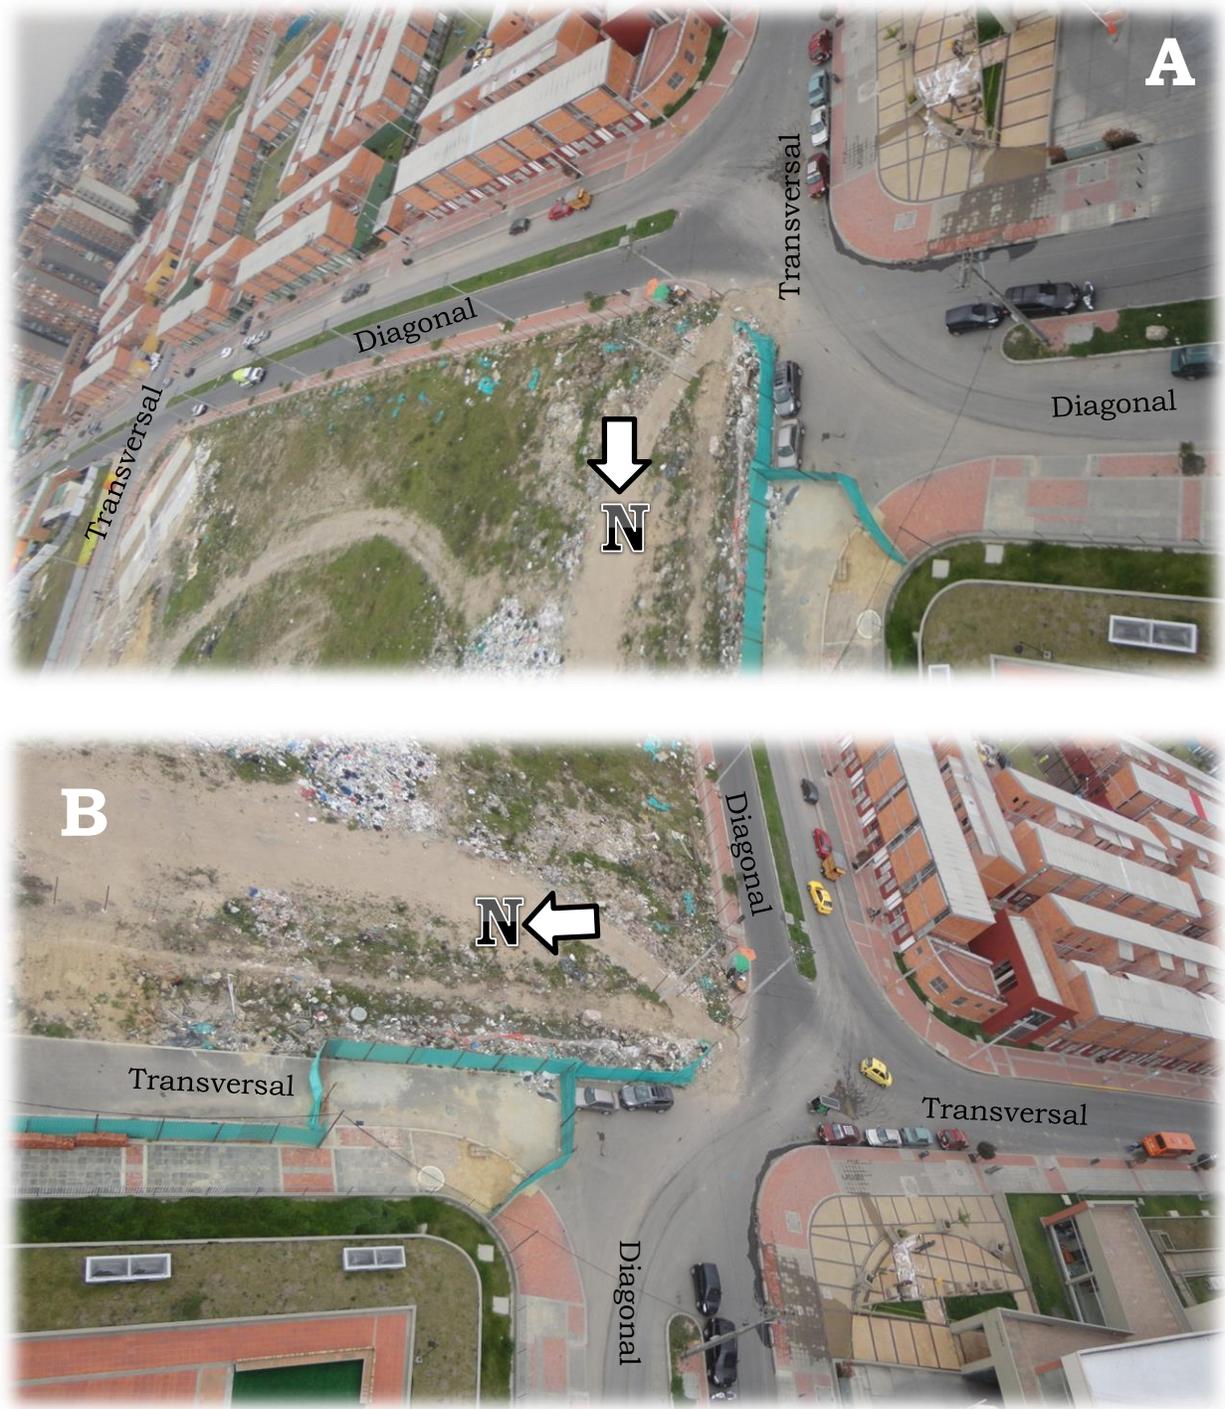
Intersección a intervenir entre la Diagonal 77B y la Transversal 129. Fuente: Archivo Propio.
